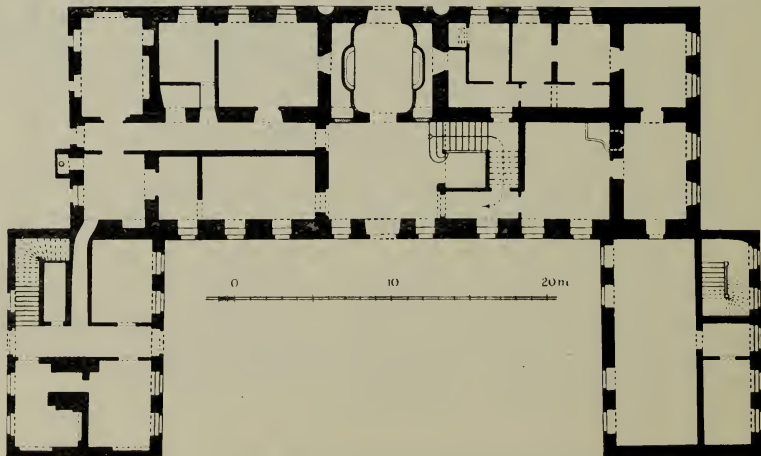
Skaska, Herrenhaus, Erdgeschoß, Grundriß.
